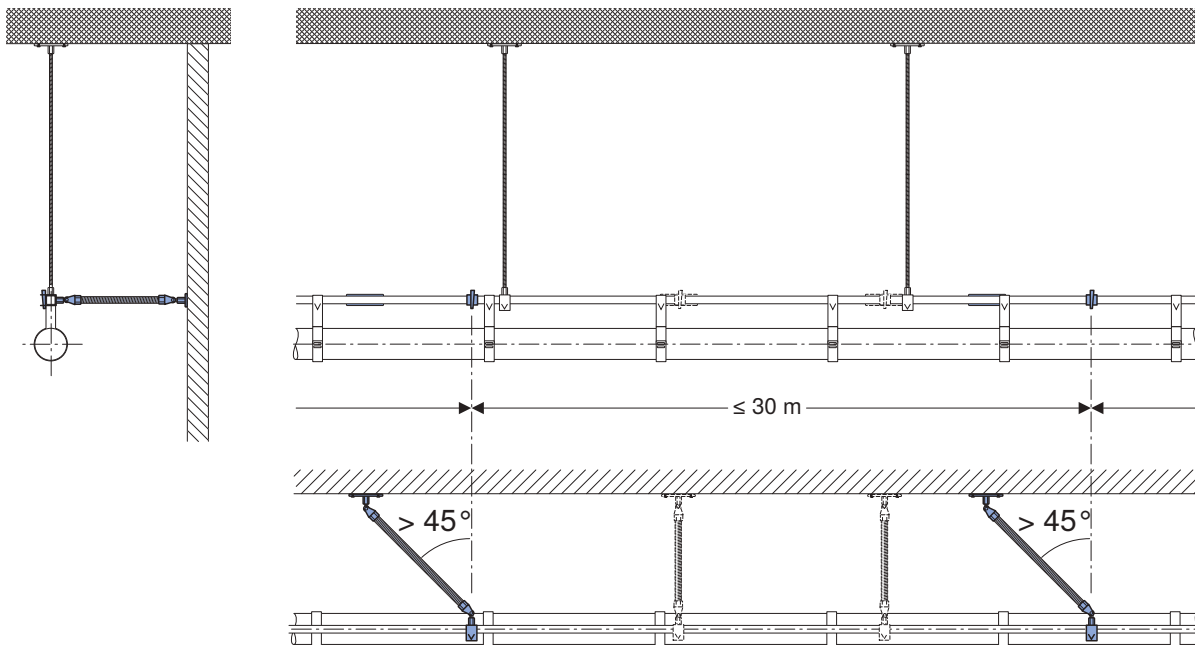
Disposition des kits de fixation de renfort Geberit Pluvia le long de la conduite sur le mur
